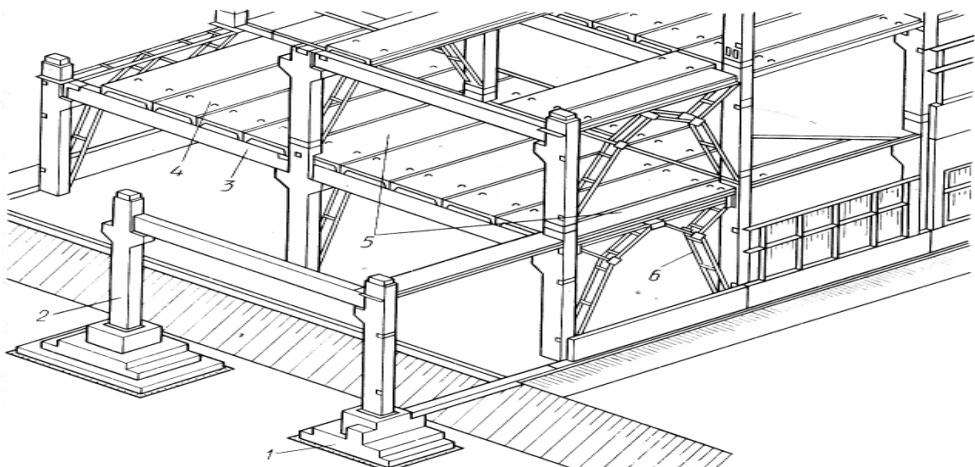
Залізобетонний каркас з плитами «на проліт».
